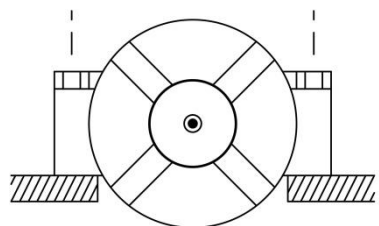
Lichtmontage – Pad-Montage, Draufsicht
